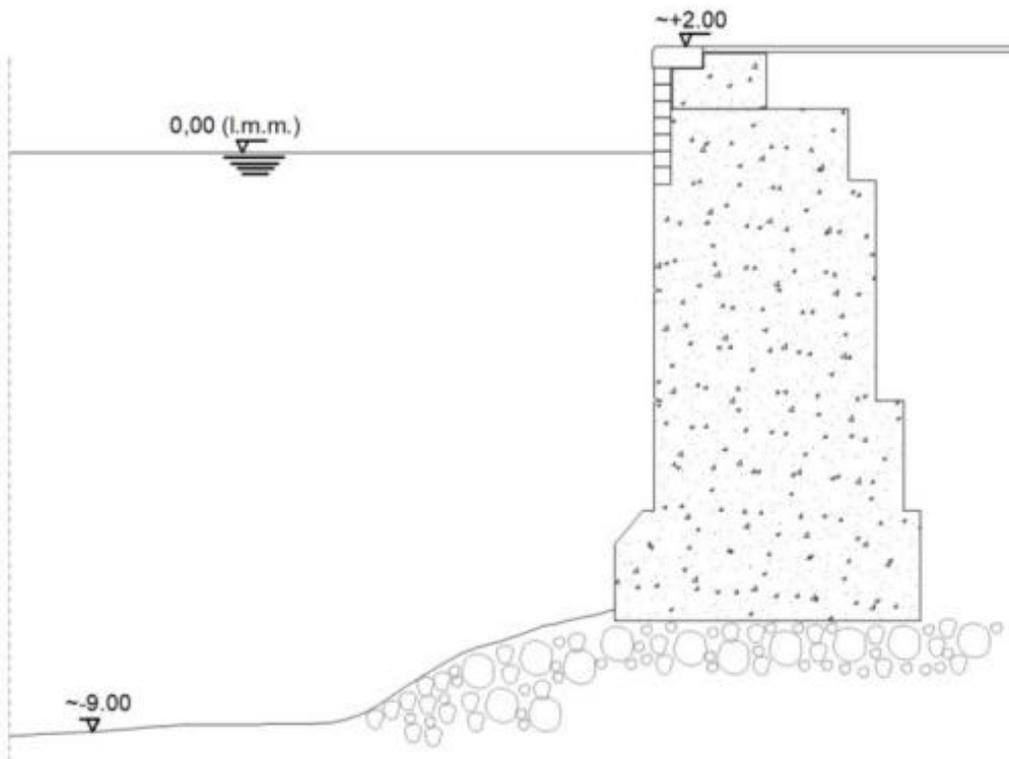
Banchina oggetto d'intervento - Sezione tipo attuale
